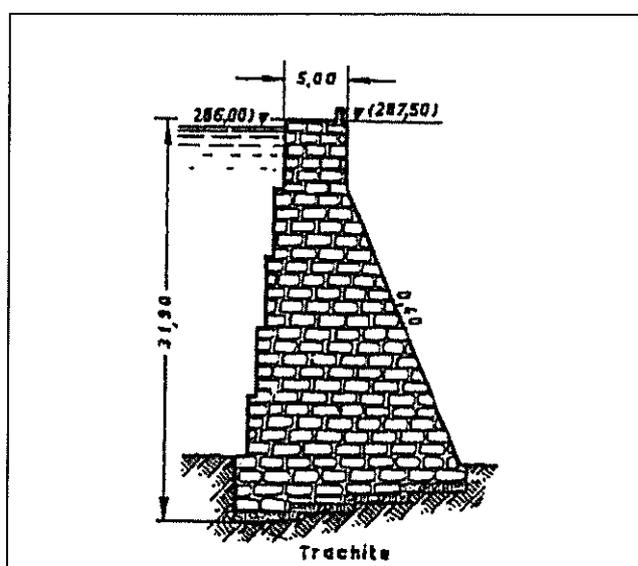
Diga di Bunnari: Sezione trasversale tipo.
